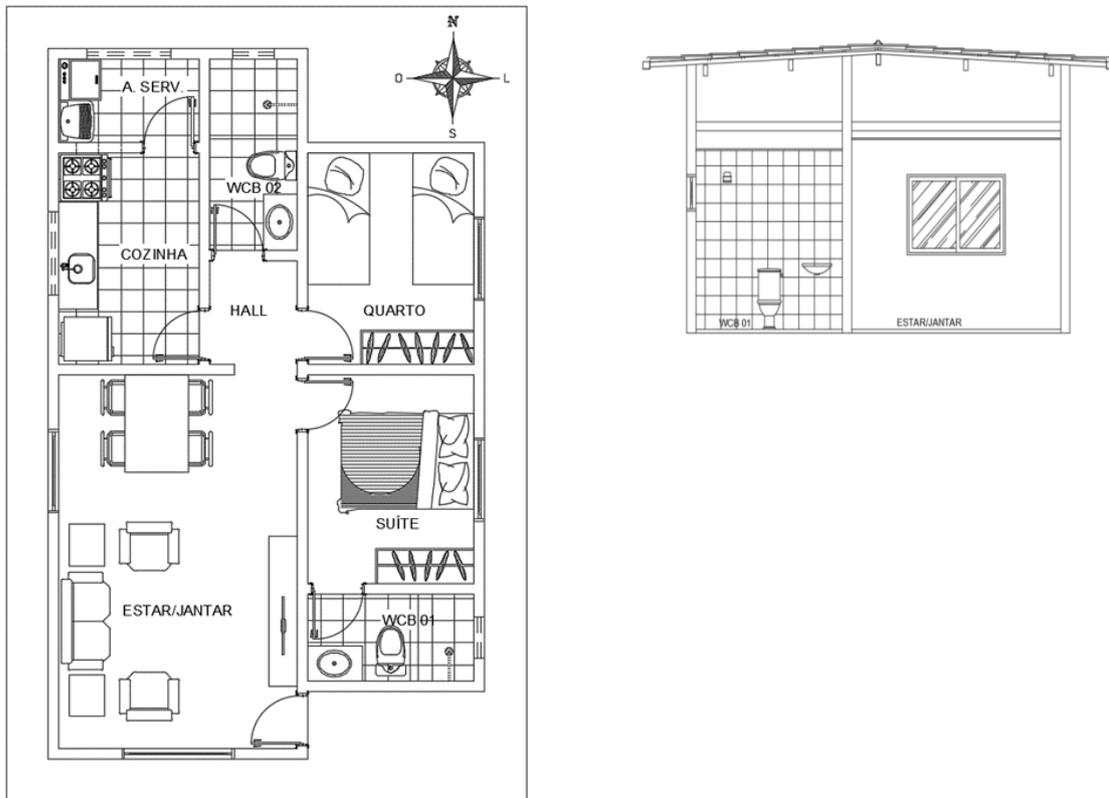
Projeto arquitetônico e planta de corte do estudo de caso
